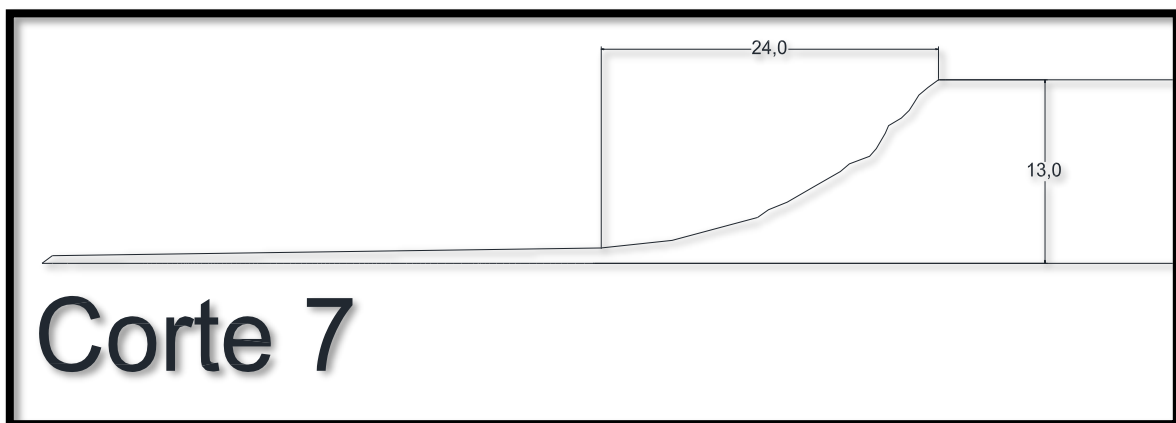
Perfil transversal de la zona homogénea adoptado (fuente: elaboración propia).
